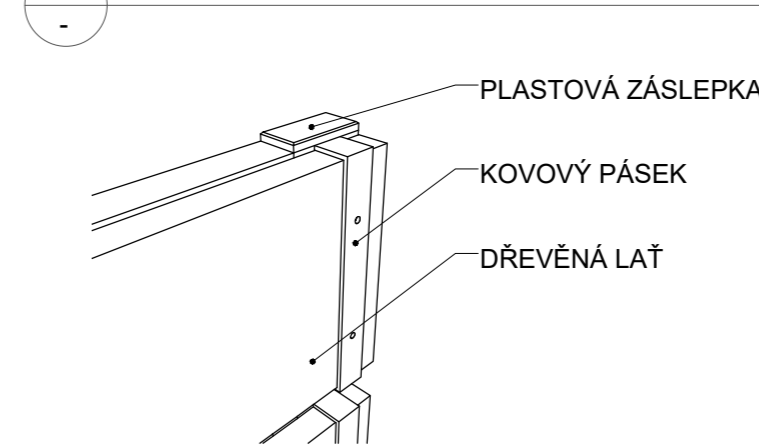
DETAIL UKOTVENÍ KONSTRUKCE M 1:10
